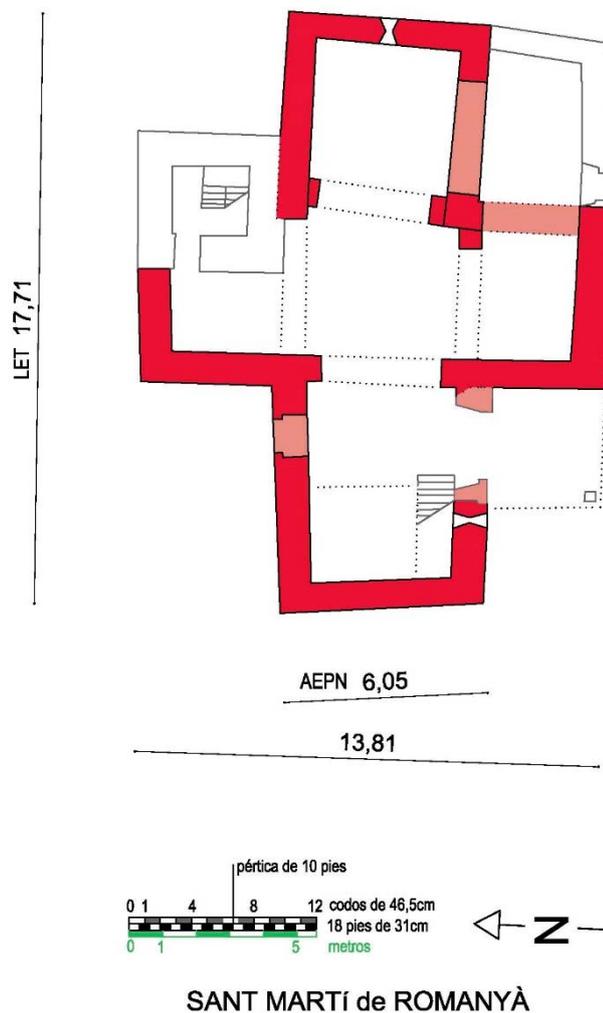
Planta crono-cromática de St. Martí. Elaborada por autora.
